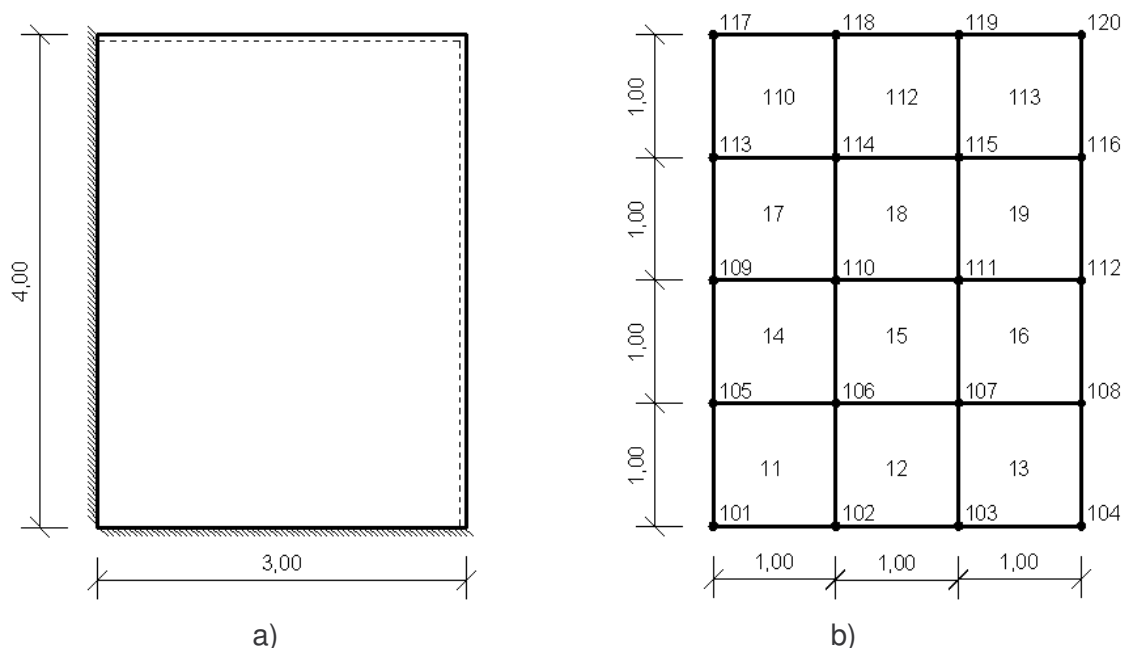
Exemplo da estrutura utilizada neste manual. a) Estrutura da laje, b) Modelação da laje
